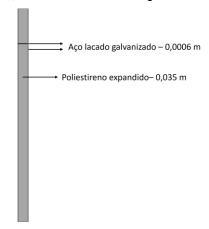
Corte transversal da porta interior e da porta de acesso externo a ${\it B}$
